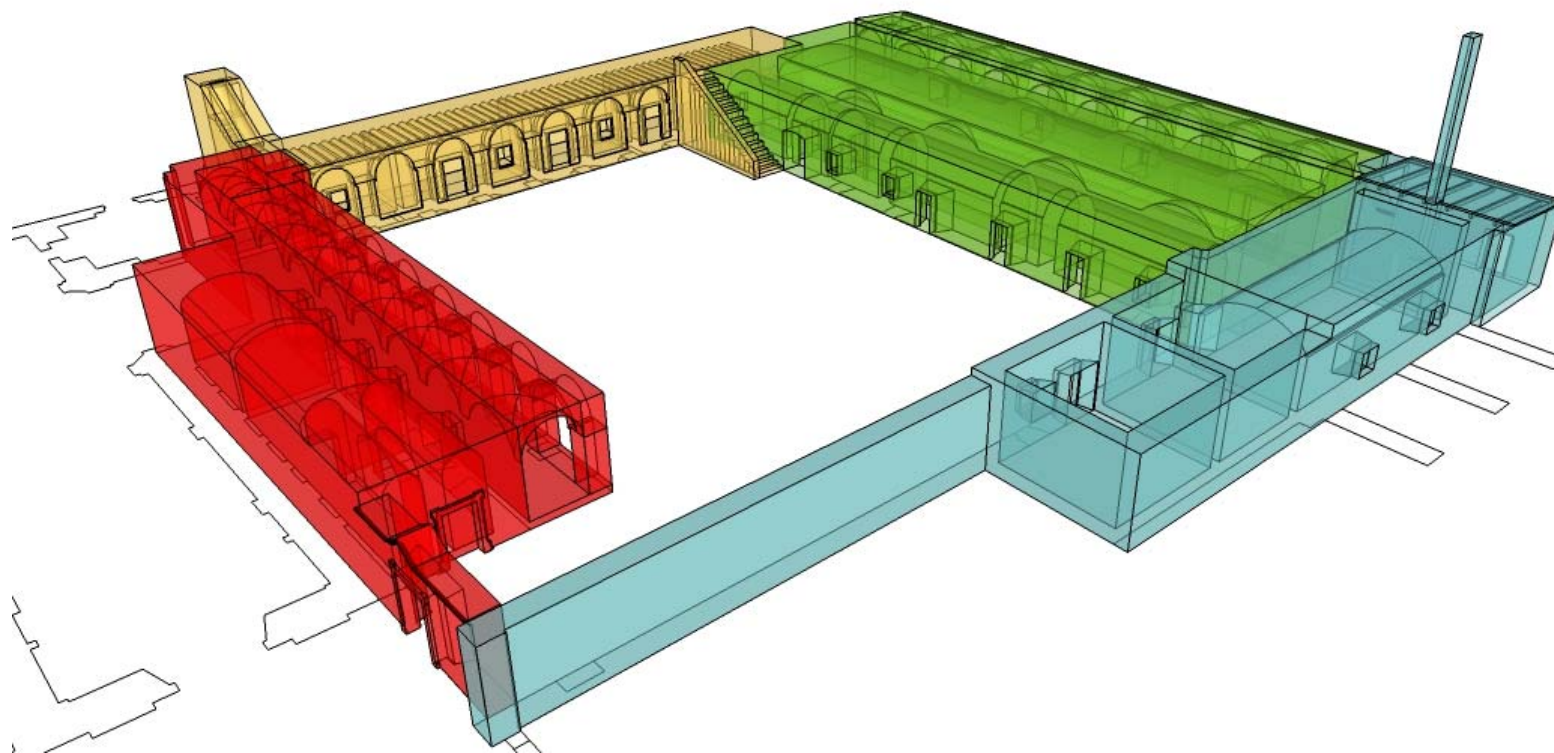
Reconstrucción Virtual. Sectores 1a, 2a, 3a, y 4a. Planta Baja
